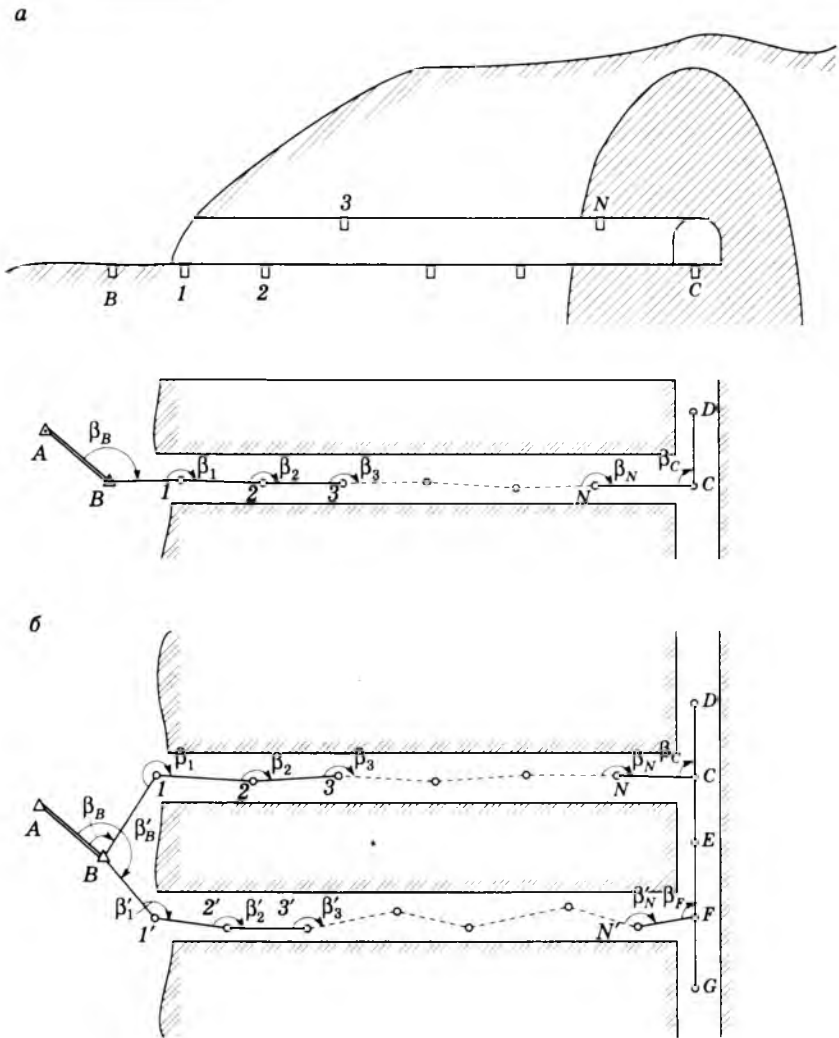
Схемы ориентирования подземных выработок через штольню (а) и две выработки (б)
